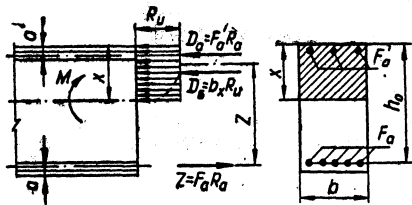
Прямоугольное сечение с двойной арматурой.
